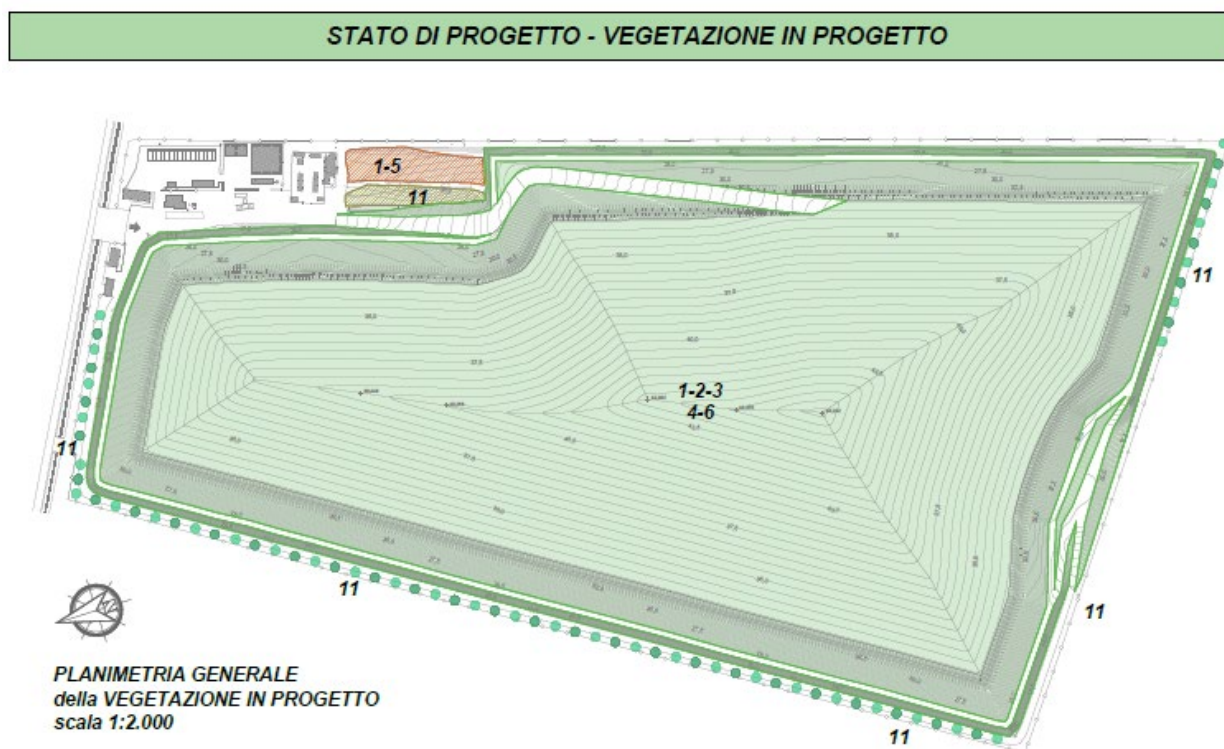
Dettaglio della vegetazione in progetto [Stralcio Tav 7.01 – Planimetria ripristino ambientale]
